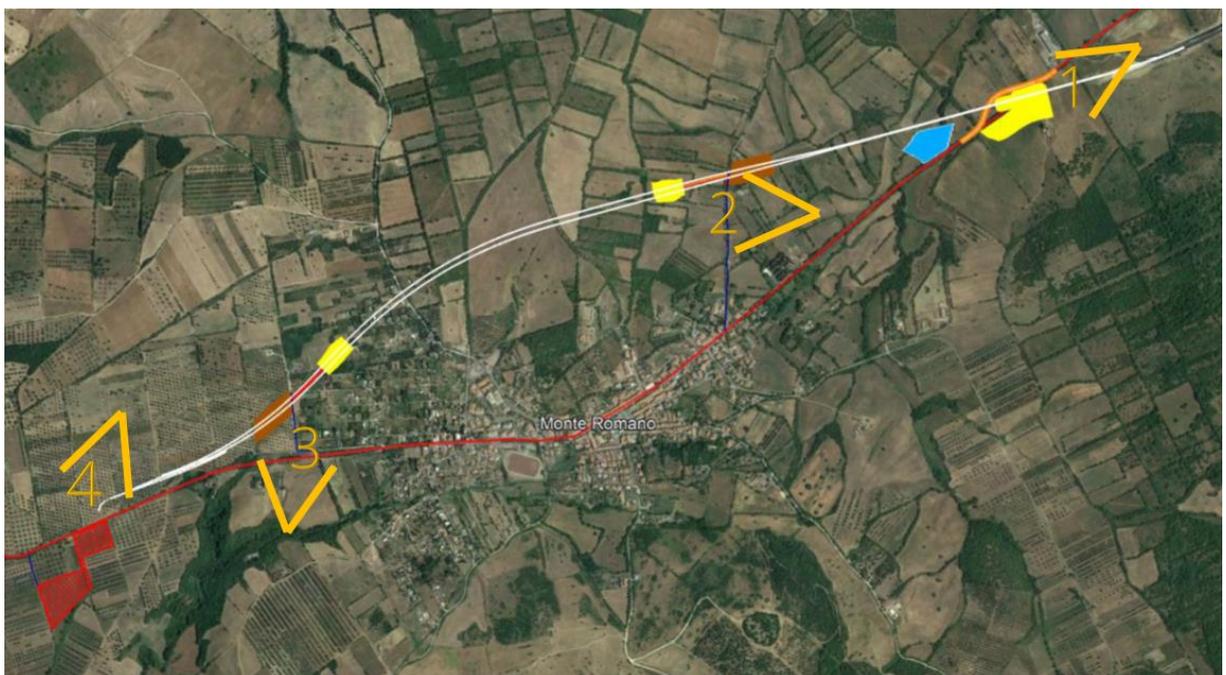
Keyplan delle aree di cantiere e del nuovo tracciato stradale della SS675
